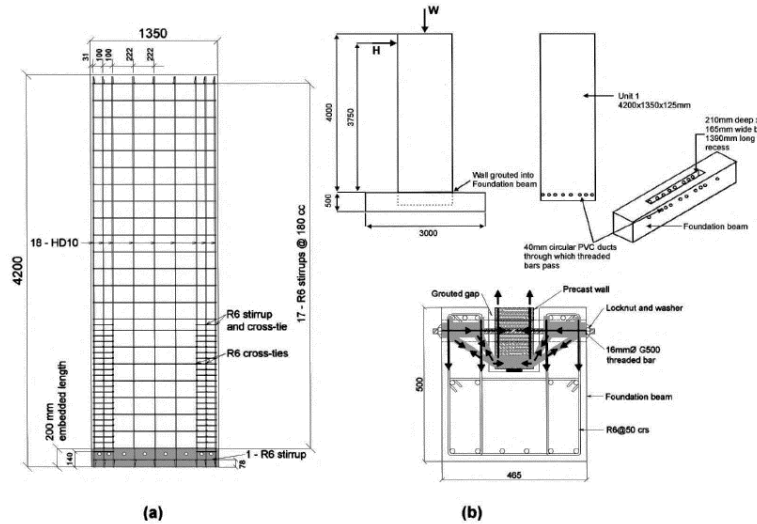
Detalles de espécimen 1. (a) Detalle del refuerzo en el muro; (b) Detalle de la conexión
